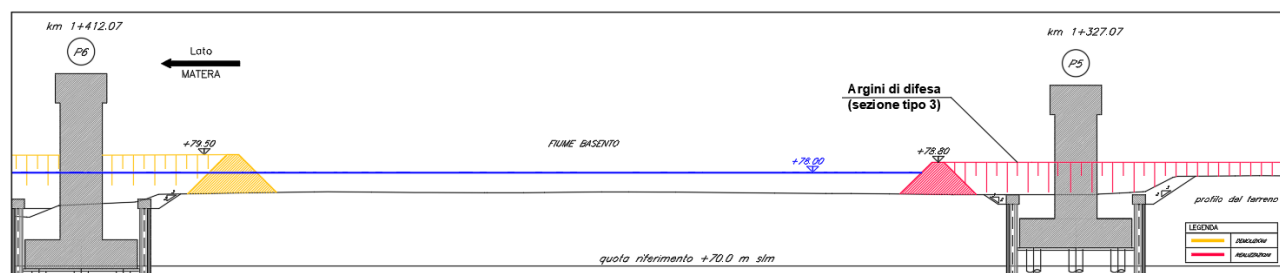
Livelli idrici nella fase di cantiere 2, in corrispondenza della sezione di attraversamento.
